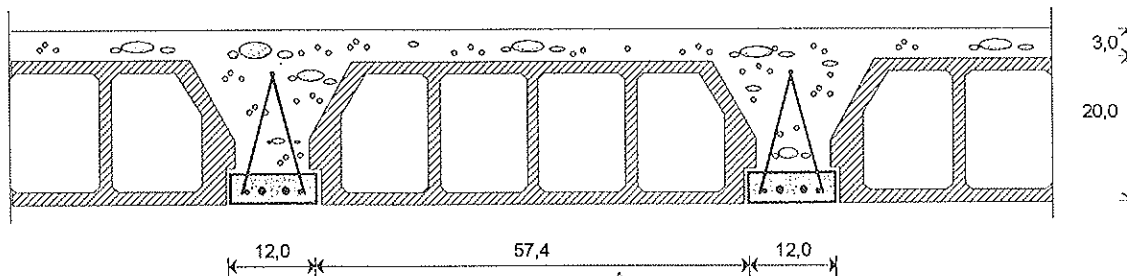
Supuesto de forjado con semiviguetas de hormigón armado. (Cotas en cm).
